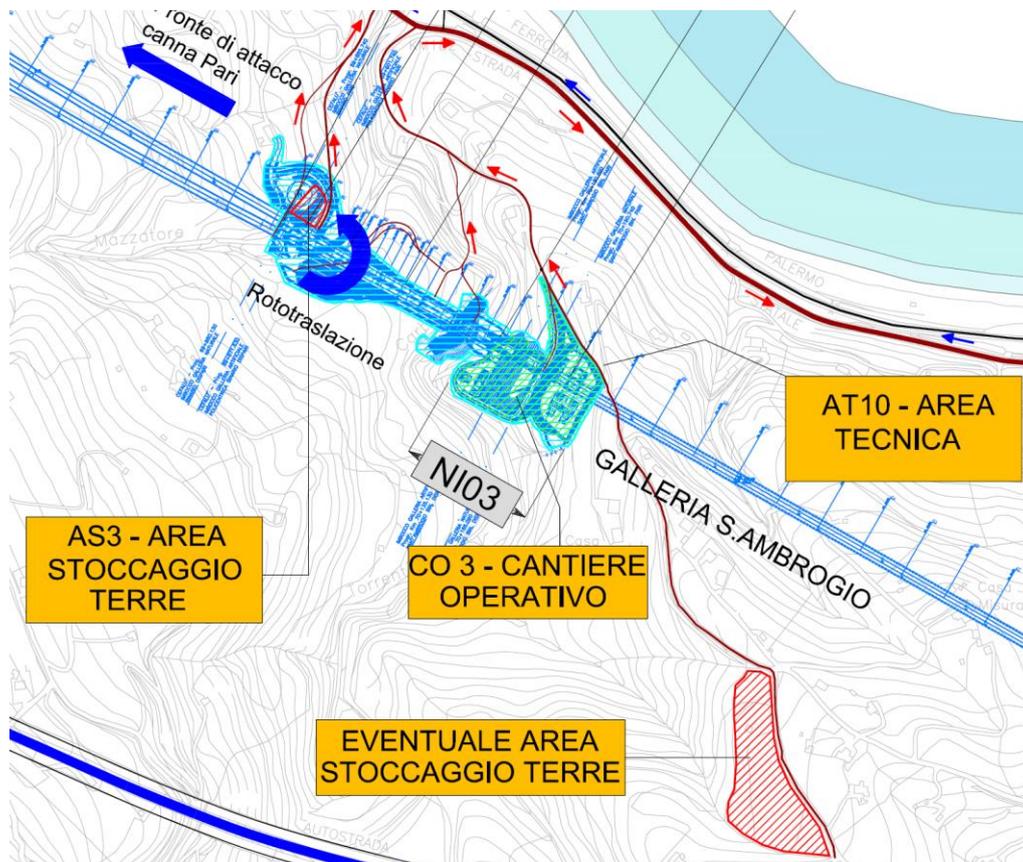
Stralcio planimetrico della Zona Carbone, con indicazione delle aree di cantierizzazione AS3, CO3 e di un'altra eventuale area di stoccaggio.
